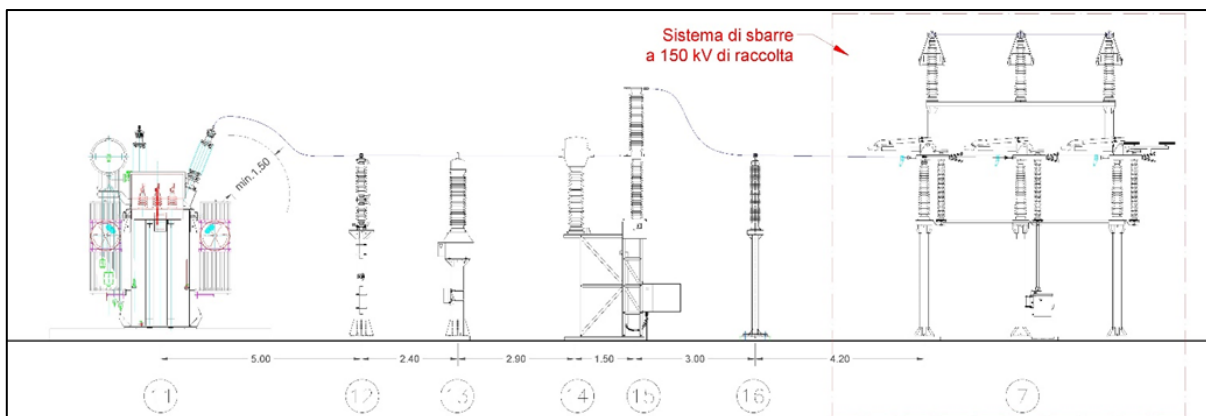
Sezione B-B' - Stallo di elevazione AT/MT
